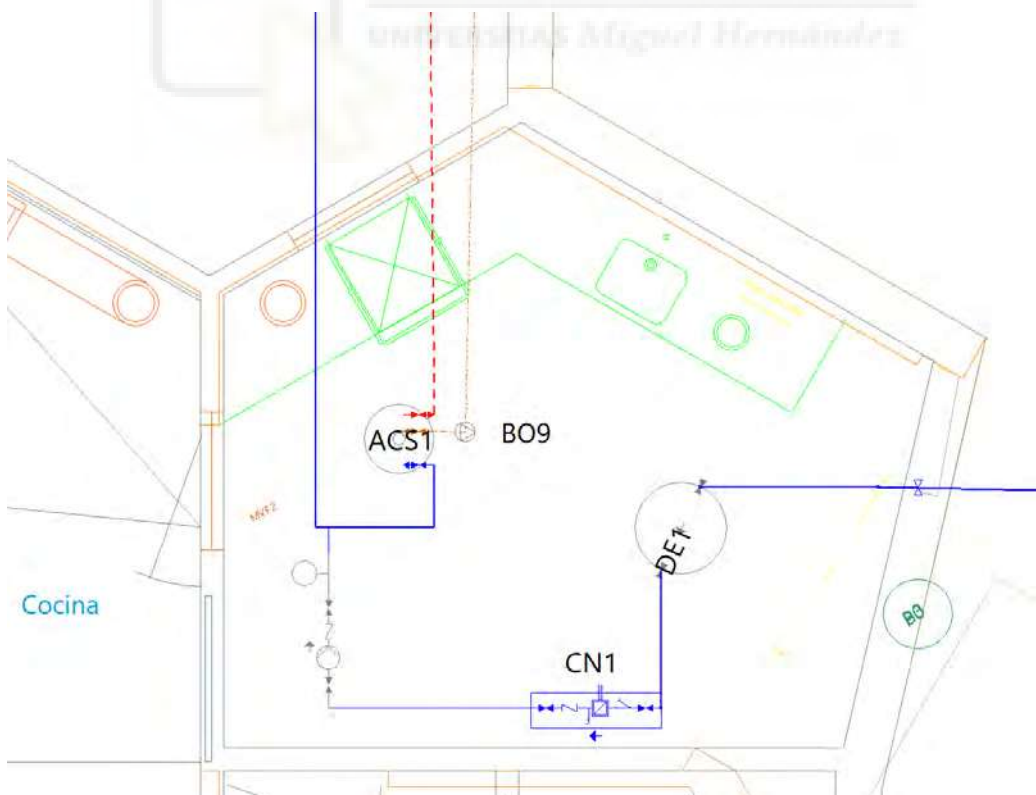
Plano detalle – Fontanería (Grupo presión)
